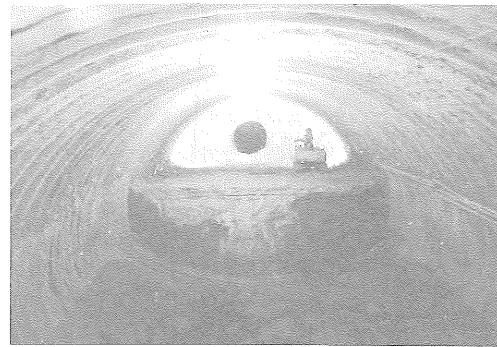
断面閉合後の上半、下半・インバート切羽状況 (上半ベンチ長24m)
